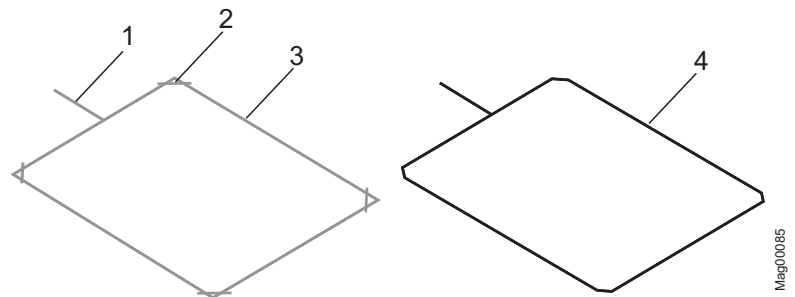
Placera induktionsslingor i bitumen, asfalt eller betong
